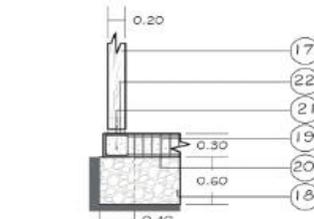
Detalle 2(Cimentación)-Esc:1/50
